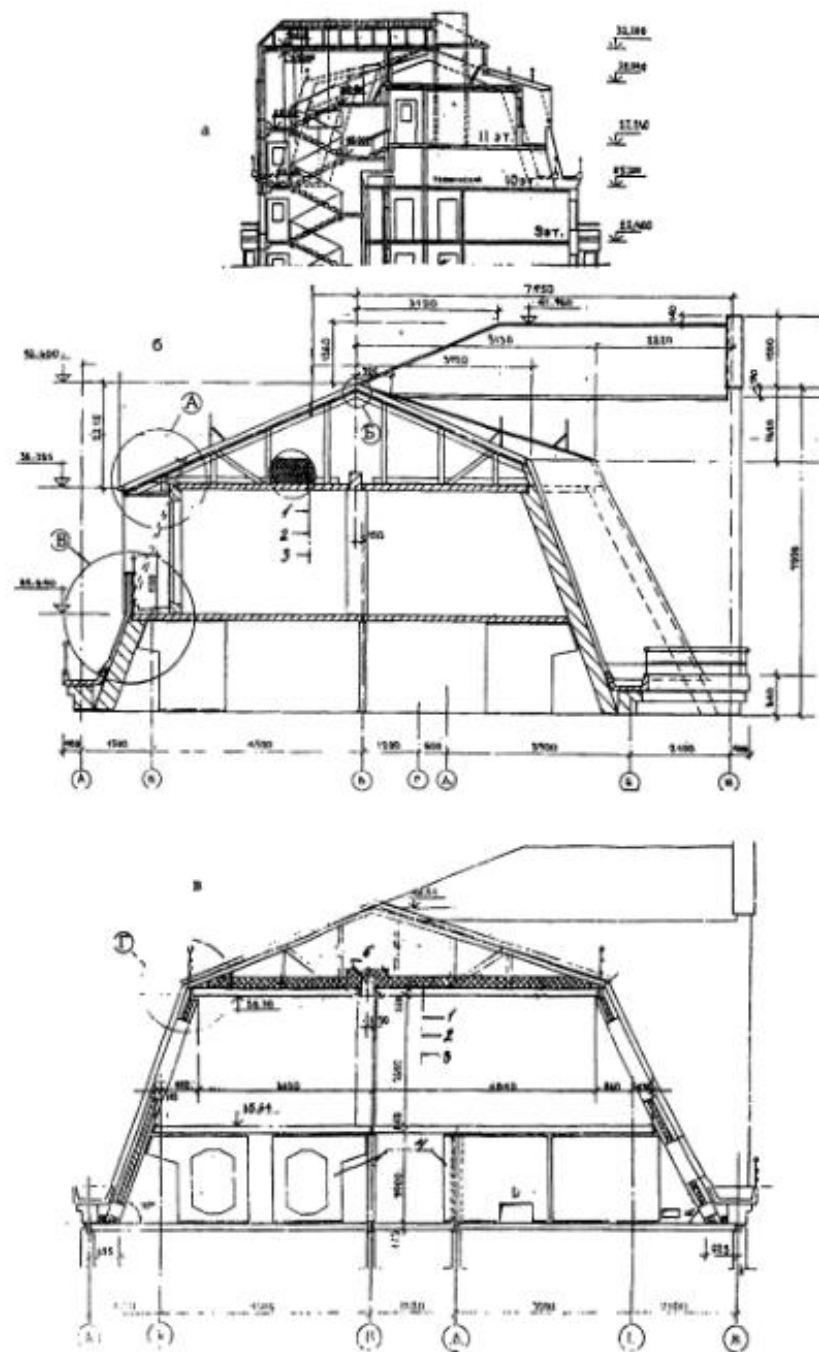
Мансардная надстройка со смешанными (железобетонными и деревянными) несущими конструкциями над 9-этажным домом: а – поперечный разрез мансарды по лестничной клетке; б – то же, в местах устройства лоджии; в – то же, при наклонных стенах жилых комнат; 1 – утеплитель; 2 – пароизоляция; 3 – железобетонная панель перекрытия; 4 – панели внутренних стен технического этажа; 5 – железобетонная балка
